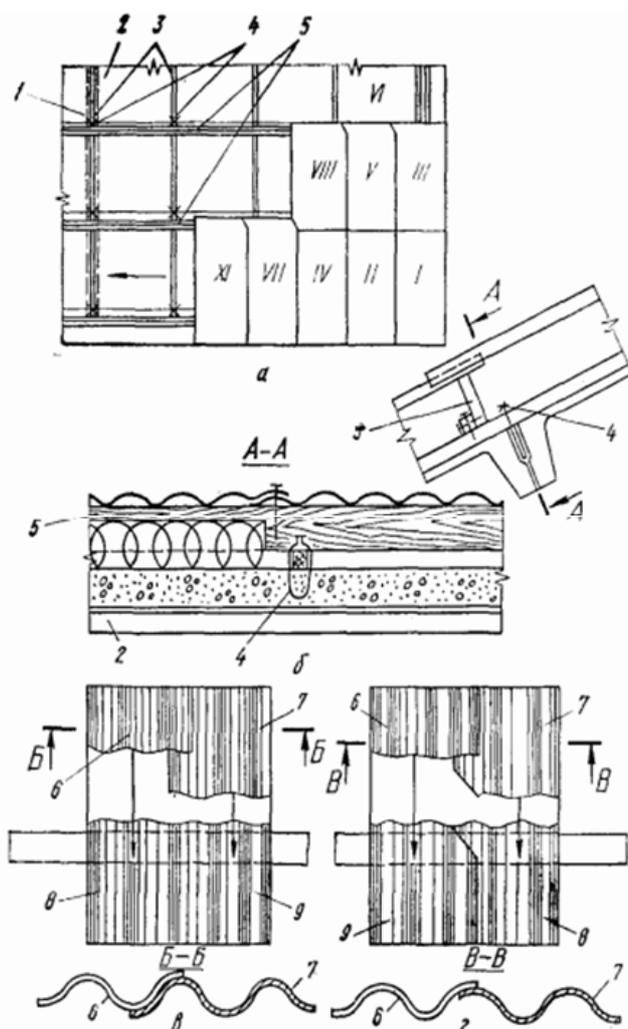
Кровля из асбестоцементных листов: а — схема укладки асбестоцементных листов; б — крепление листов к обрешетке по железобетонным плитам; в — укладка листов со смещением кромок; г — то же, с обрезкой углов; I, ..., XI — последовательность укладки листов; 1 — железобетонная ферма; 2 — железобетонные плиты; 3 — деревянные бруски; 4 — проволочные скрутки; 5 — доска обрешетки; 6 — второй лист второго ряда; 7 — первый лист второго ряда; 8 — первый лист первого ряда; 9 — второй лист первого ряда
